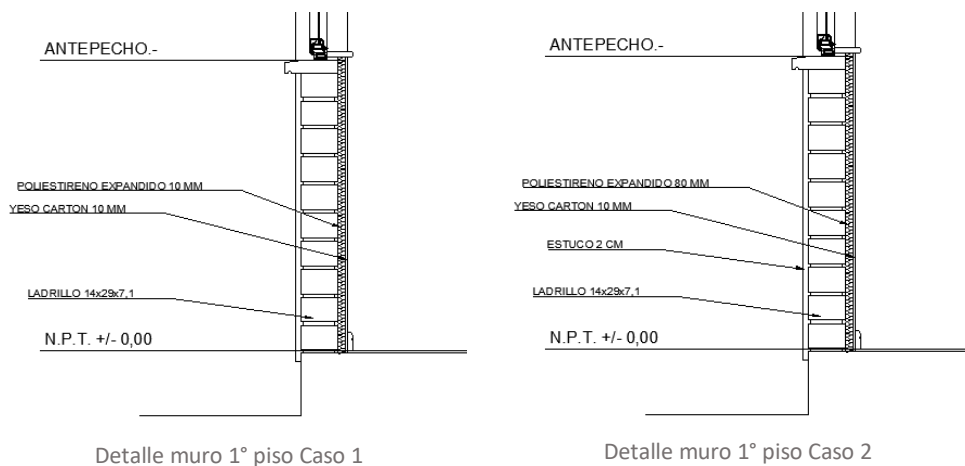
Detalles constructivos de la envolvente térmica del muro del 1° piso para ambos casos de estudio.
